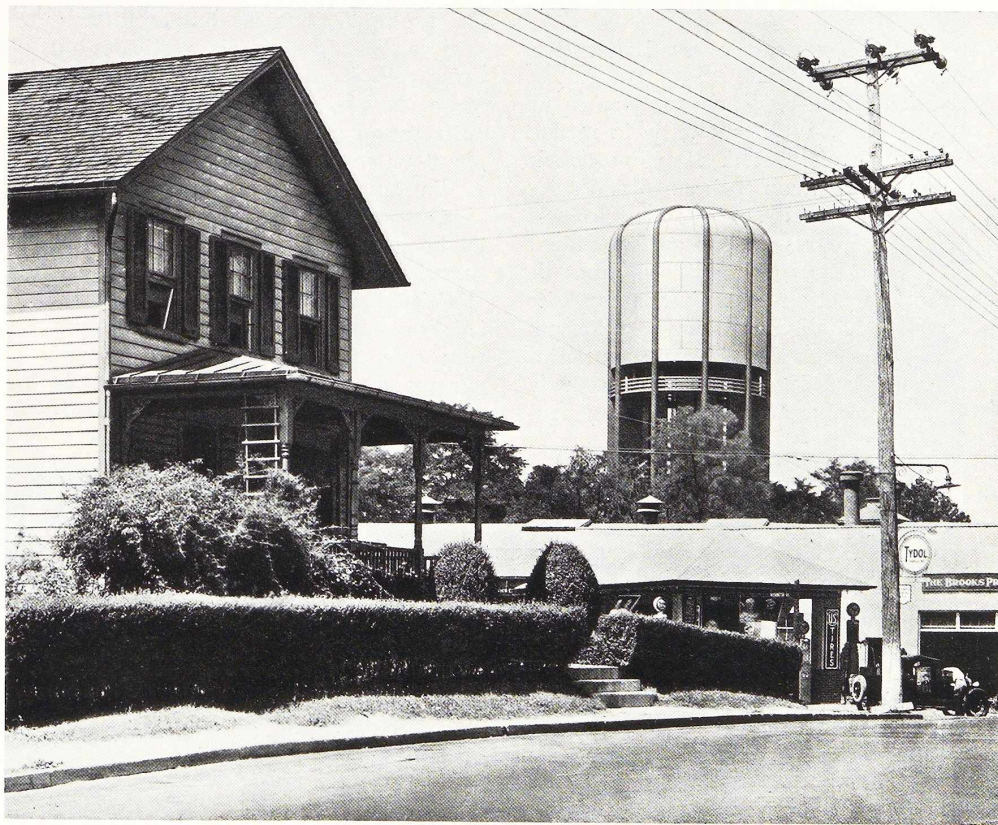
Le château d'eau de Baltimore. Construit à Towson, Md., au sommet d'une colline, l'ouvrage est vu à grande distance. Son plan résulte d'un concours ouvert entre les architectes.
